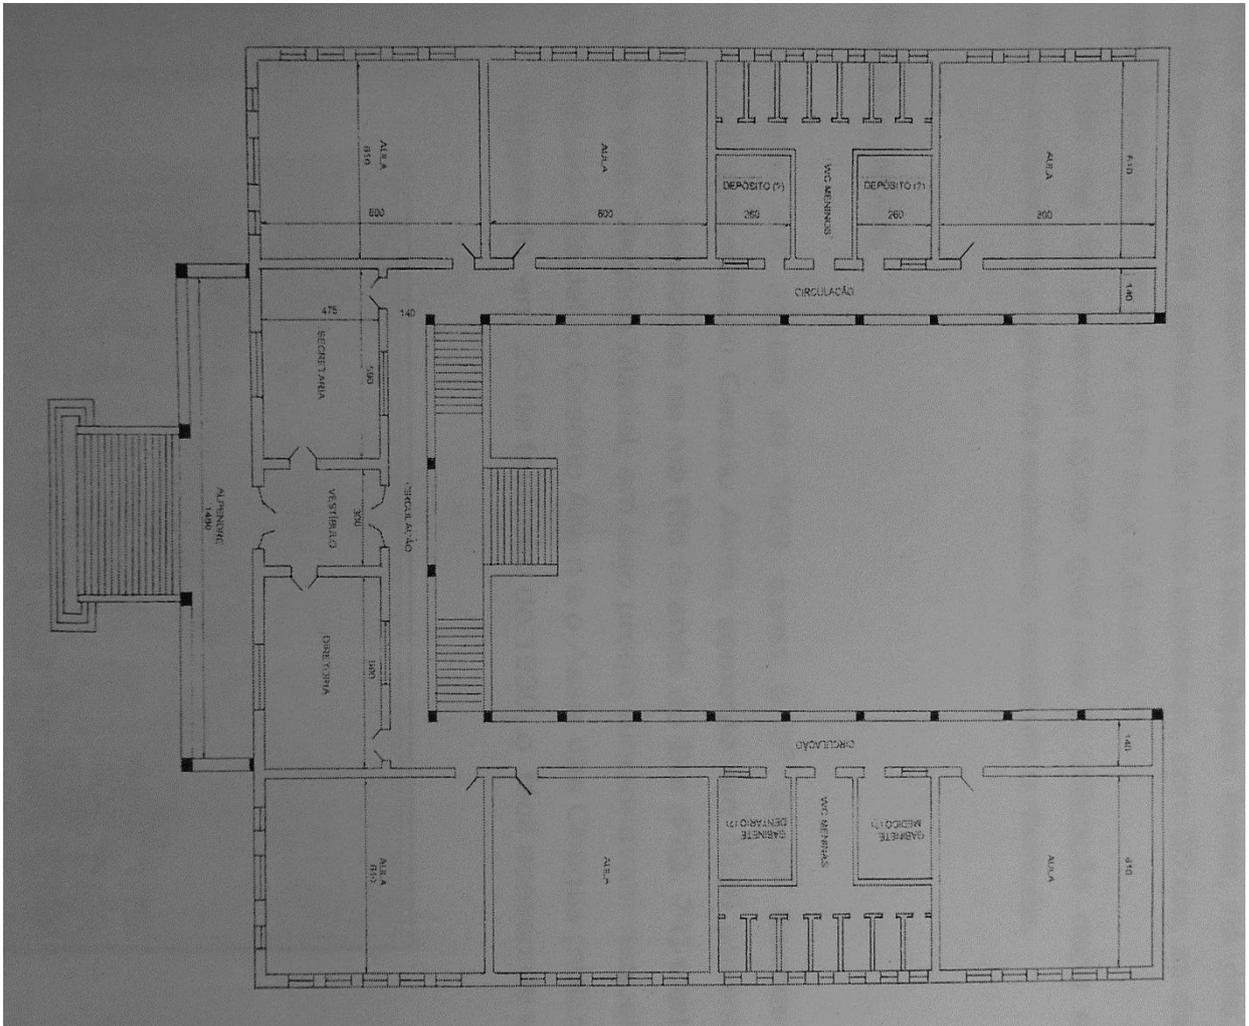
Planta do pavimento superior do G.E Pedro II
